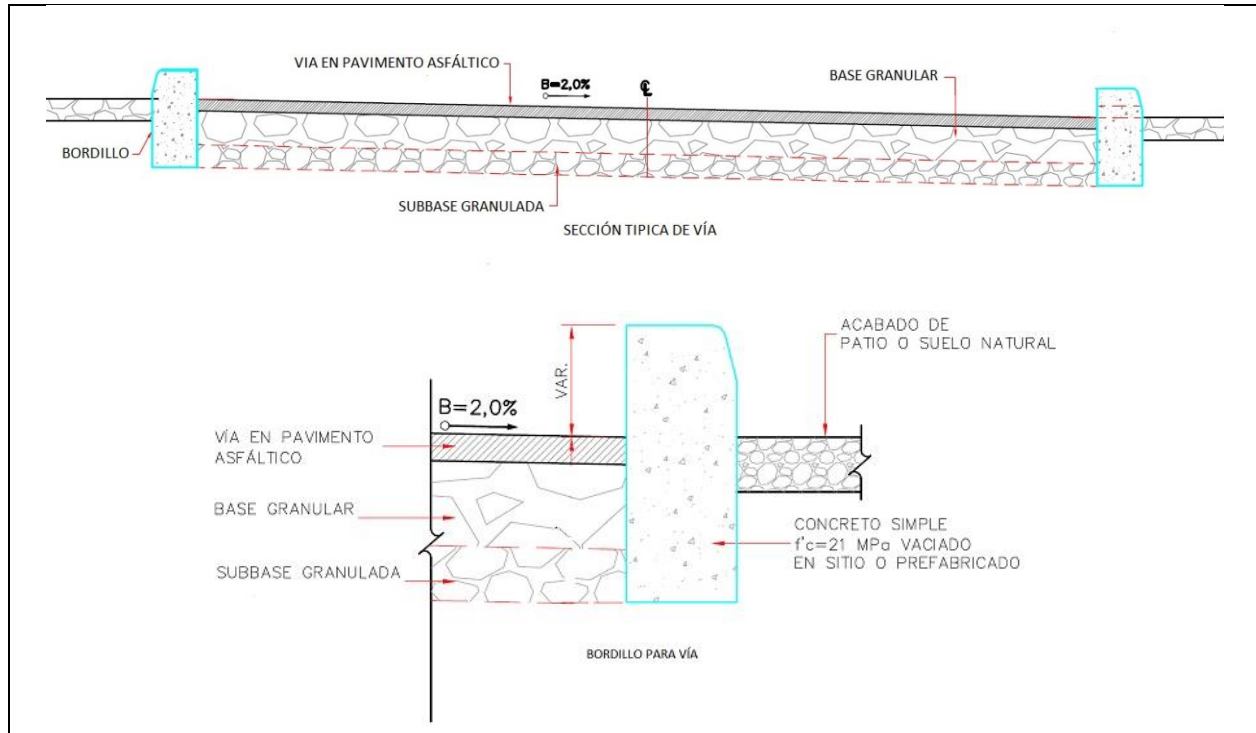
Secciones y detalles tipo de la vía de acceso a construir
